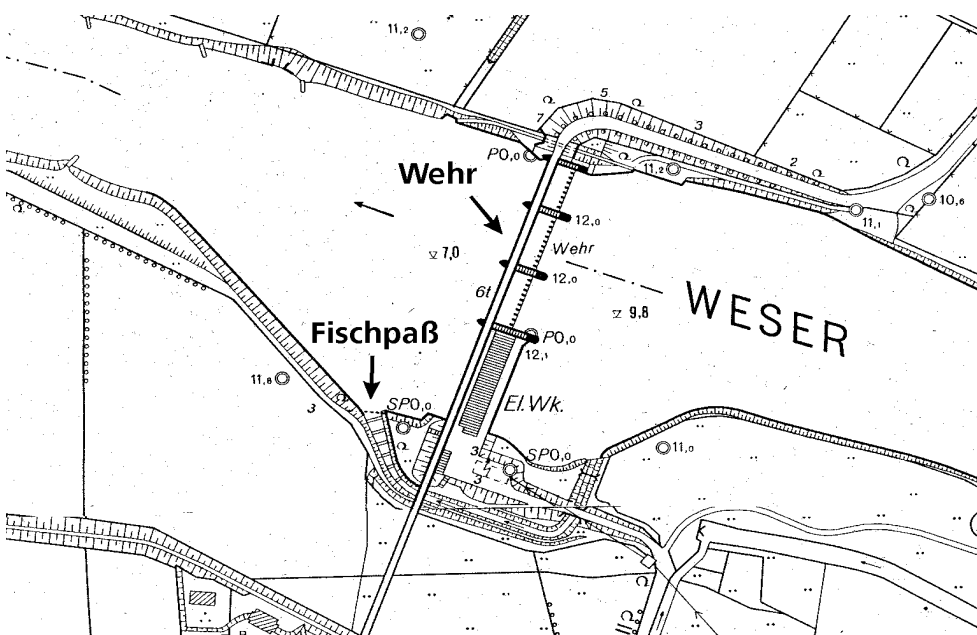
Lageplan der Wehranlage Langwedel
